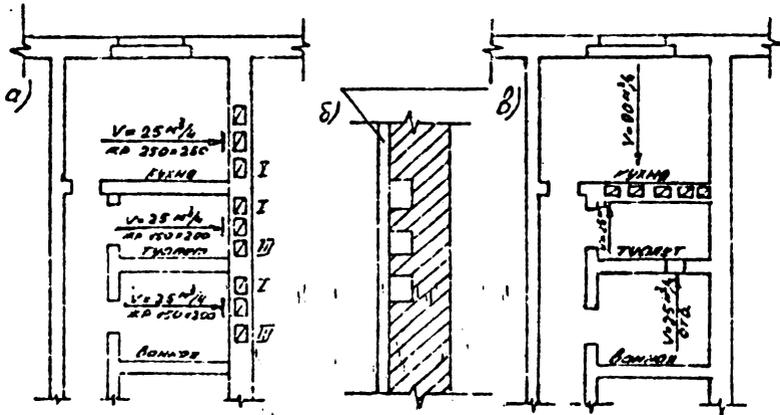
Устройство вентиляционных каналов: а) во внутренней кирпичных стенах; б) в бороздах стены; в) с использованием вентиляционных панелей.
